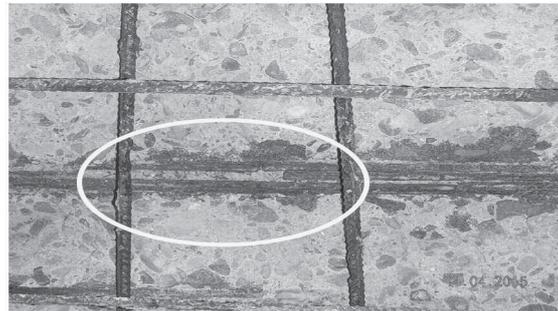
Spanndrahtbruch (gelb markiert) in der Fahrbahnplatte einer Autobahnbrücke (Baujahr 1972) infolge Chloridkorrosion
